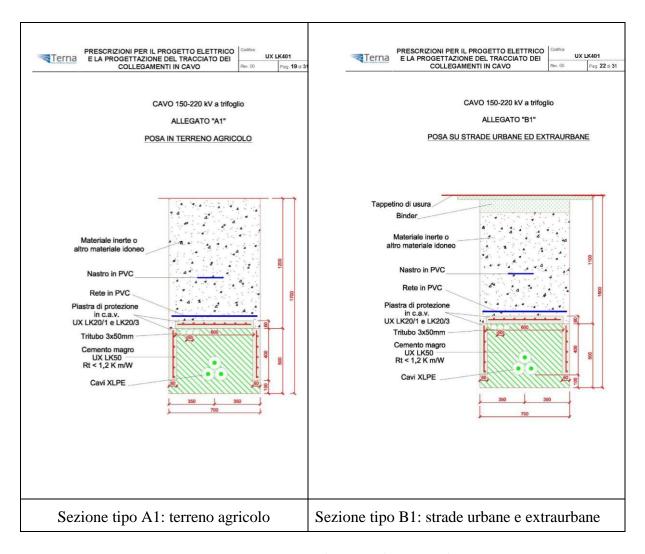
Sezione tipo di posa cavidotto AT 150 kV
